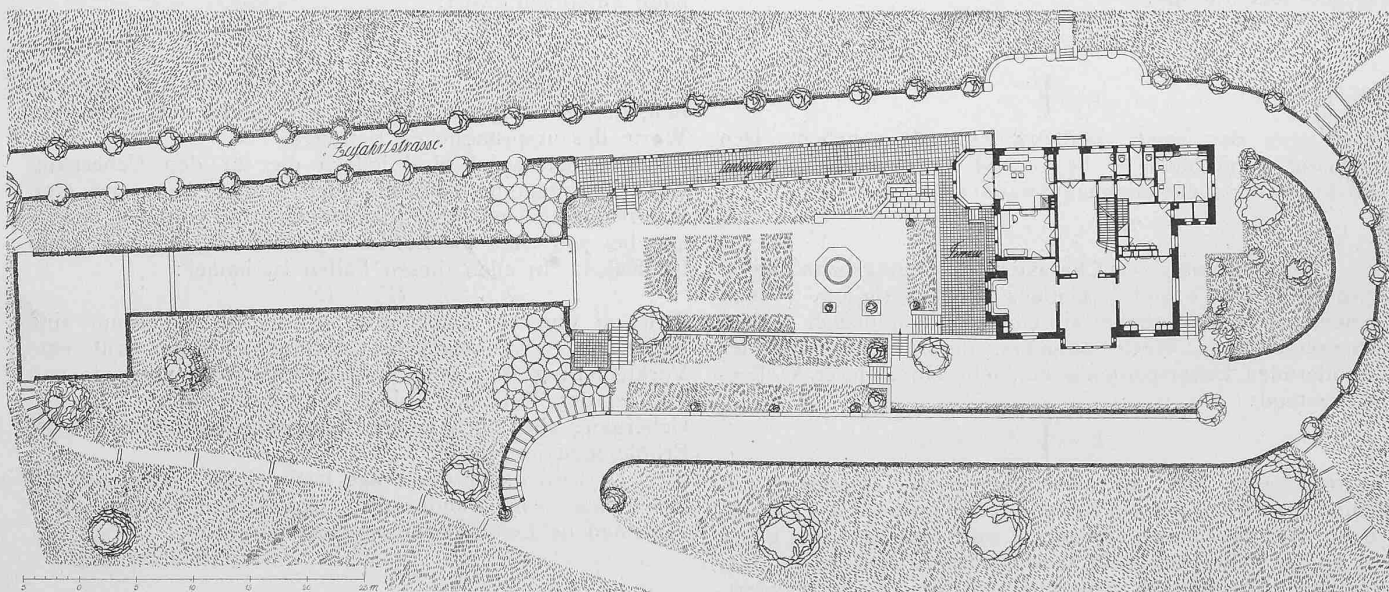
Lageplan des Wohnhauses Blattmann in Wädenswil. — Masstab 1 : 600.
